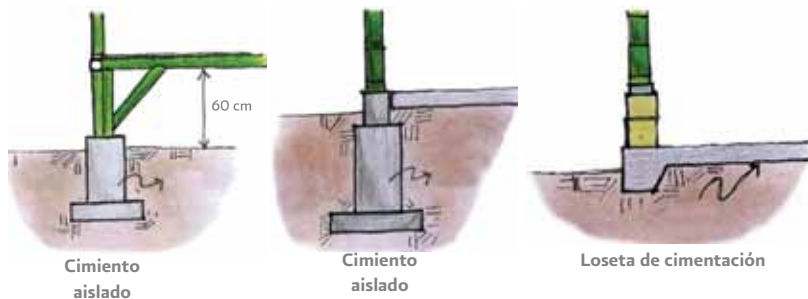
Ejemplos de cimentaciones aisladas para construcciones elevadas.
